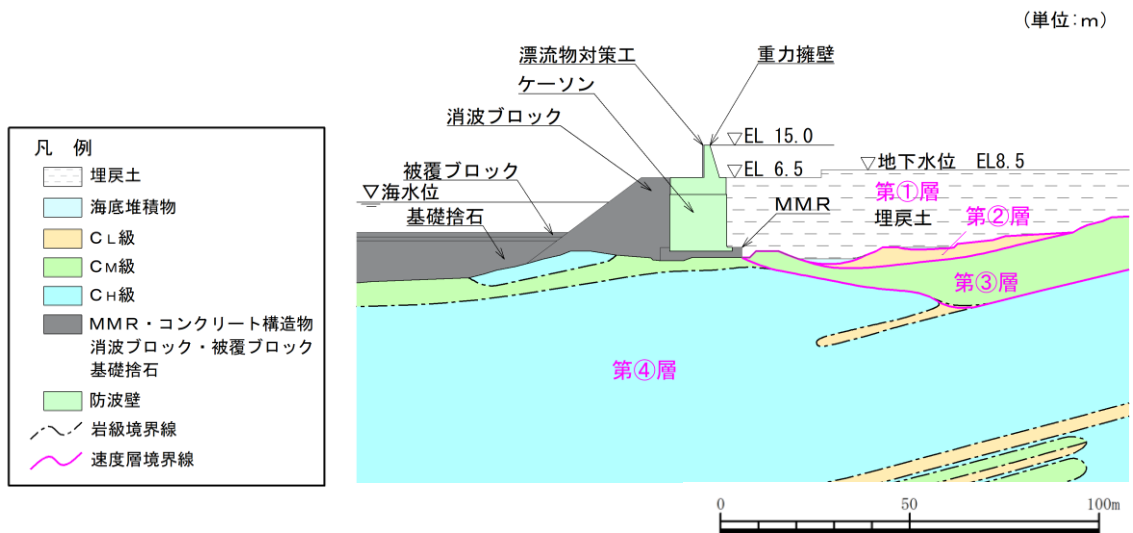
(1) 地質断面図 (防波壁 (波返重力擁壁) ①-①断面 (参考))
